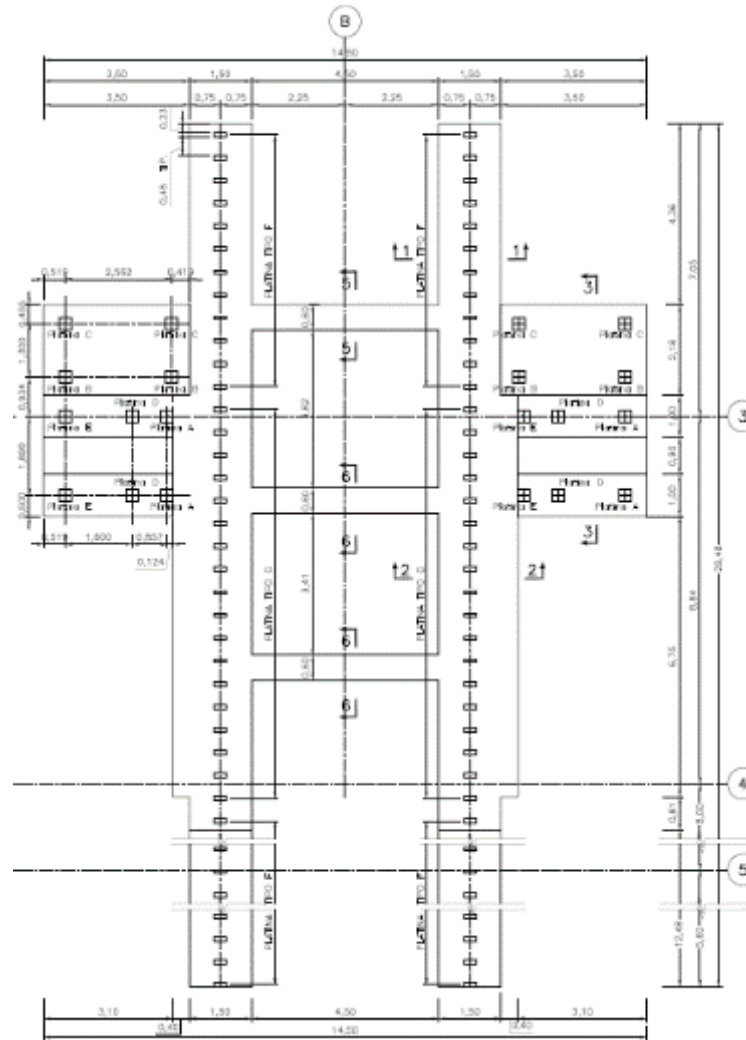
Vista en planta de pedestal de viga fabricado con viga 1 U
